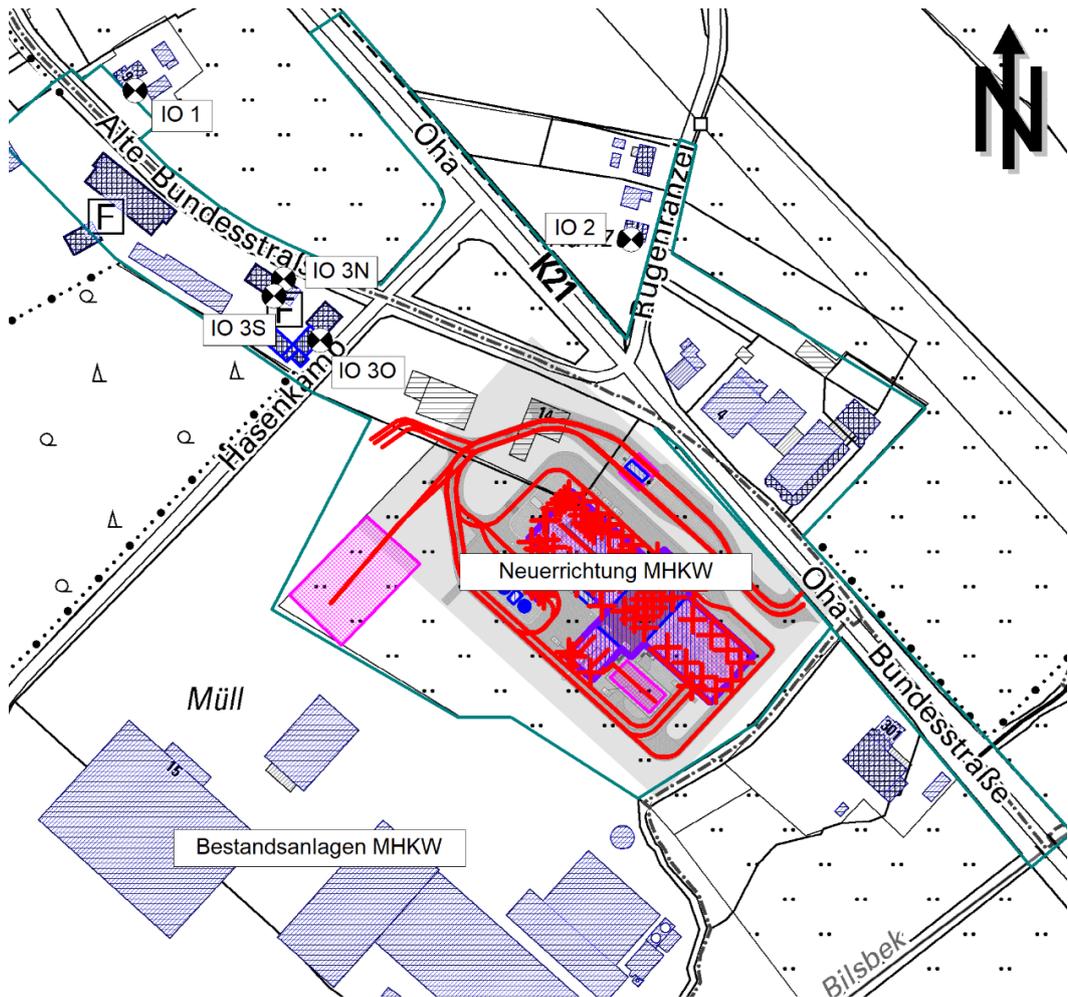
Lageplan: Geplanter Anlagenstandort MHKW mit Umgebung und Immissionsorten.
